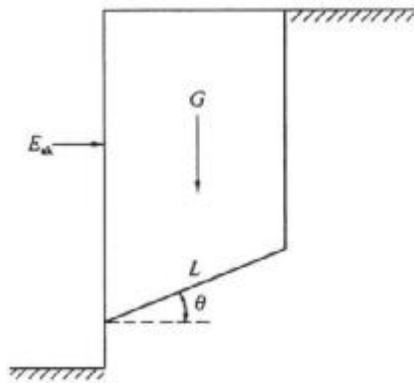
岩质边坡四边形滑裂时侧向压力计算
